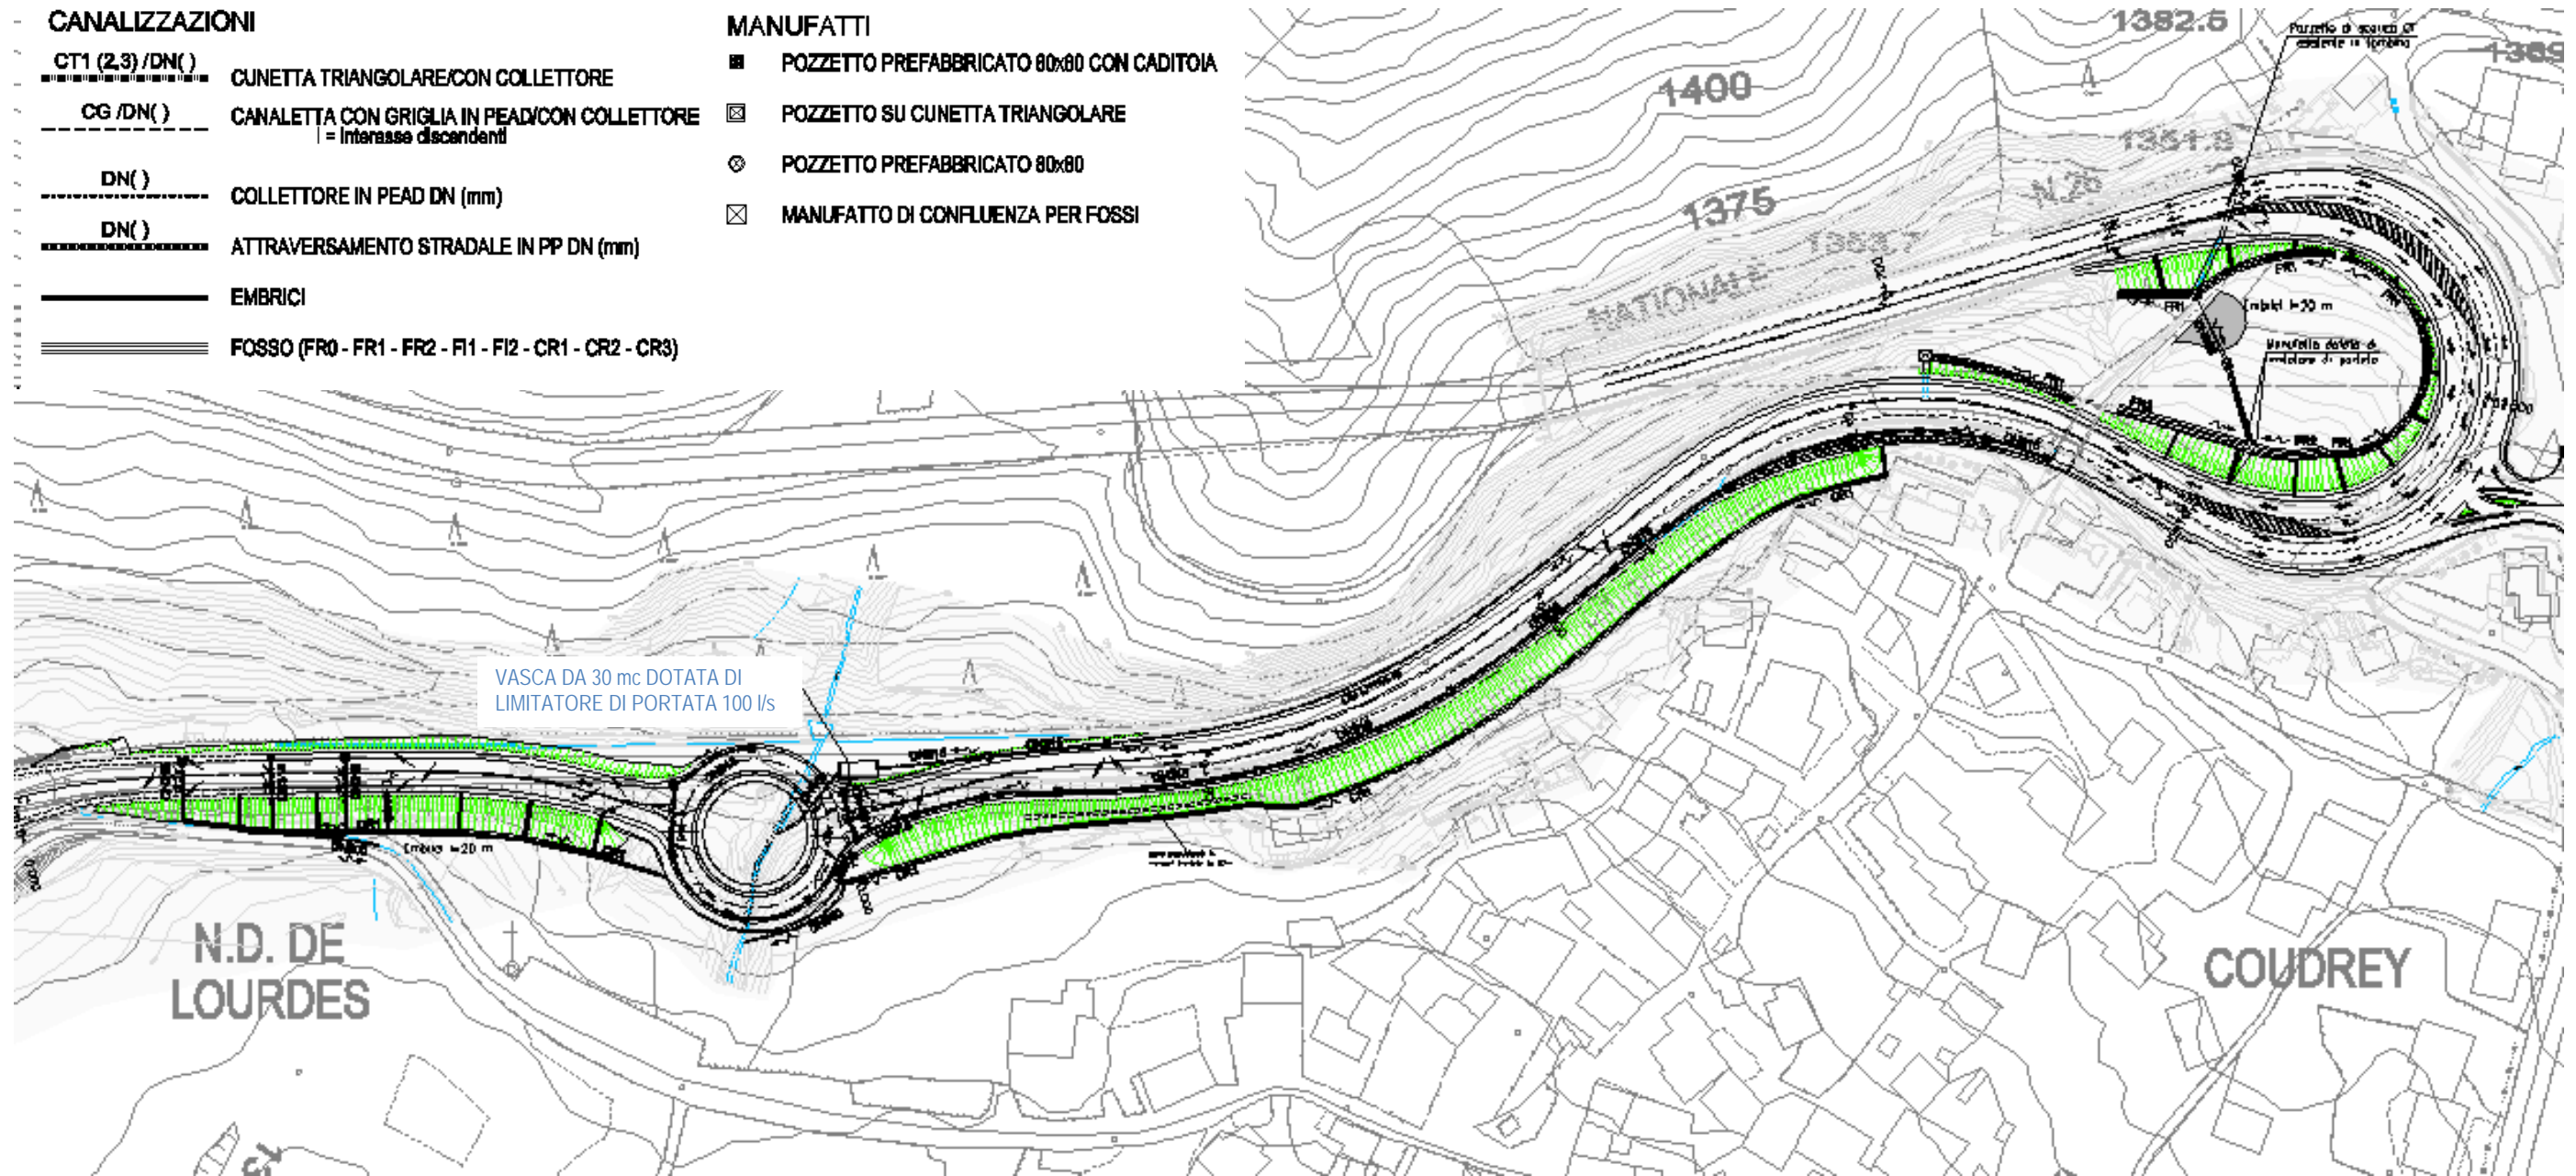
PLANIMETRIA IDRAULICA DI PROGETTO
